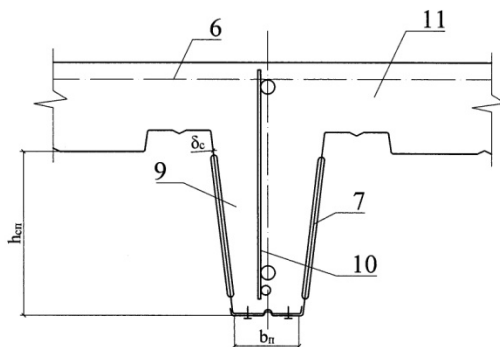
Фрагмент сталежелезобетонного перекрытия здания [3], где: 6 - верхняя арматурная сетка; 7 - поперечные ребра жесткости; 9 - кессонообразователь;
